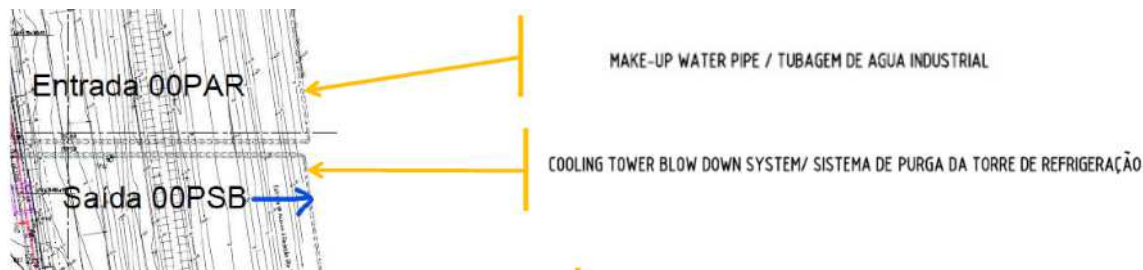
Outros atravessamentos de tubagens da nova Central do Ribatejo (Pormenores 1 e 2)
